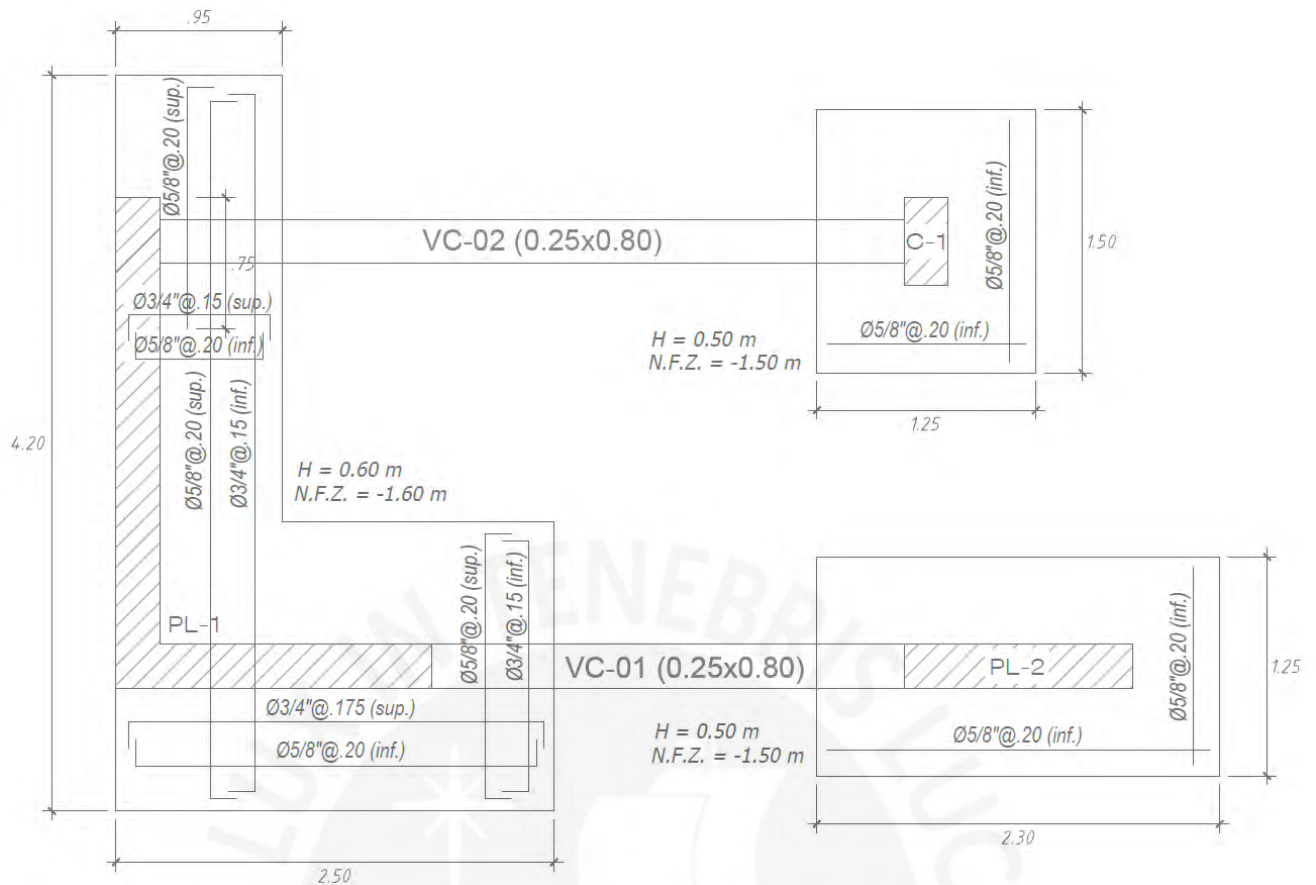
Refuerzo por flexión colocado a las zapatas conectadas analizadas
